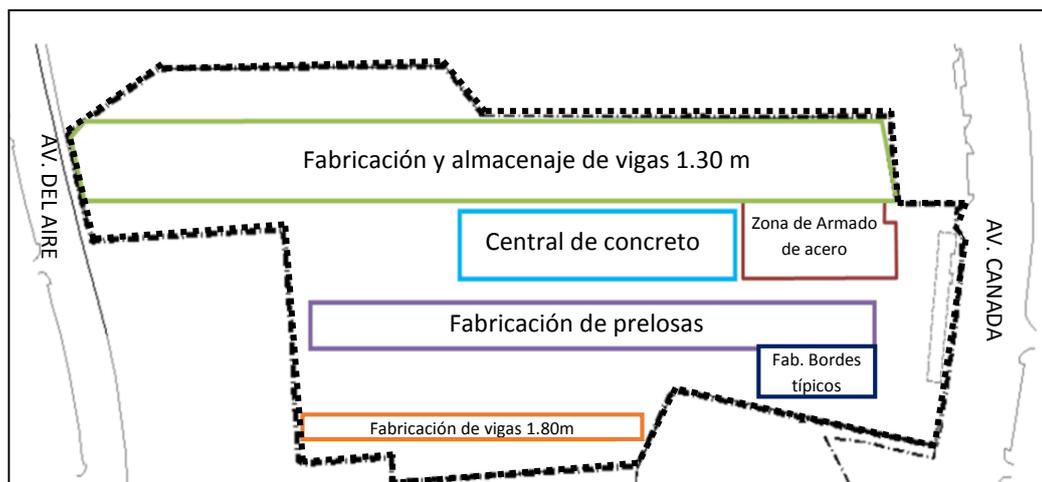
Distribución definitiva de áreas de trabajo en la planta de prefabricados del tramo 1 de la construcción del viaducto del tren eléctrico
